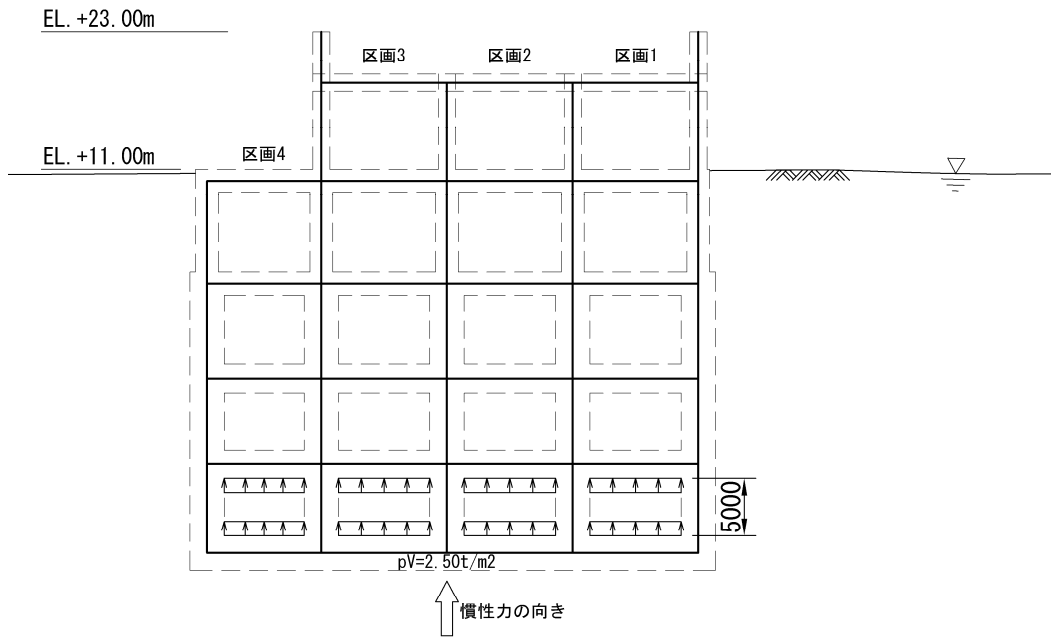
(2) 鉛直動による動水圧図 (南北方向⑤-⑤断面)
